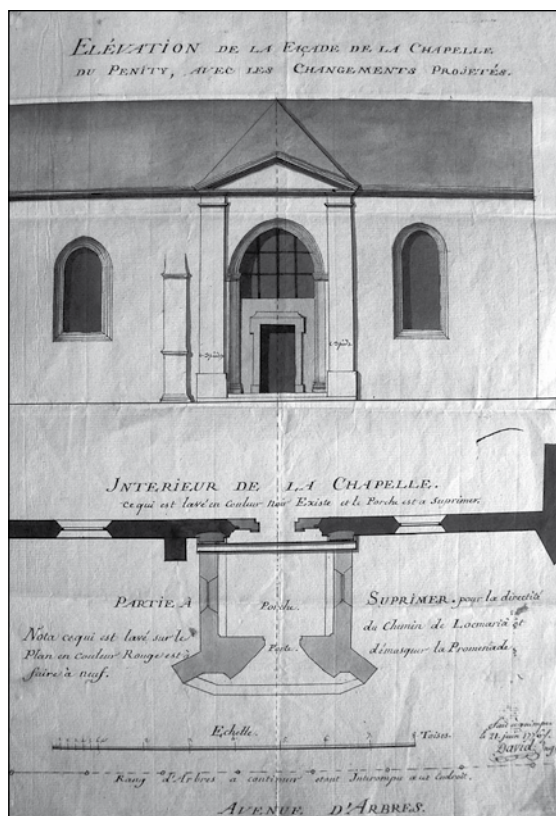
Quimper, *chapelle du Penity*, élévation et plan, par l'ingénieur David, 21 juin 1776.
